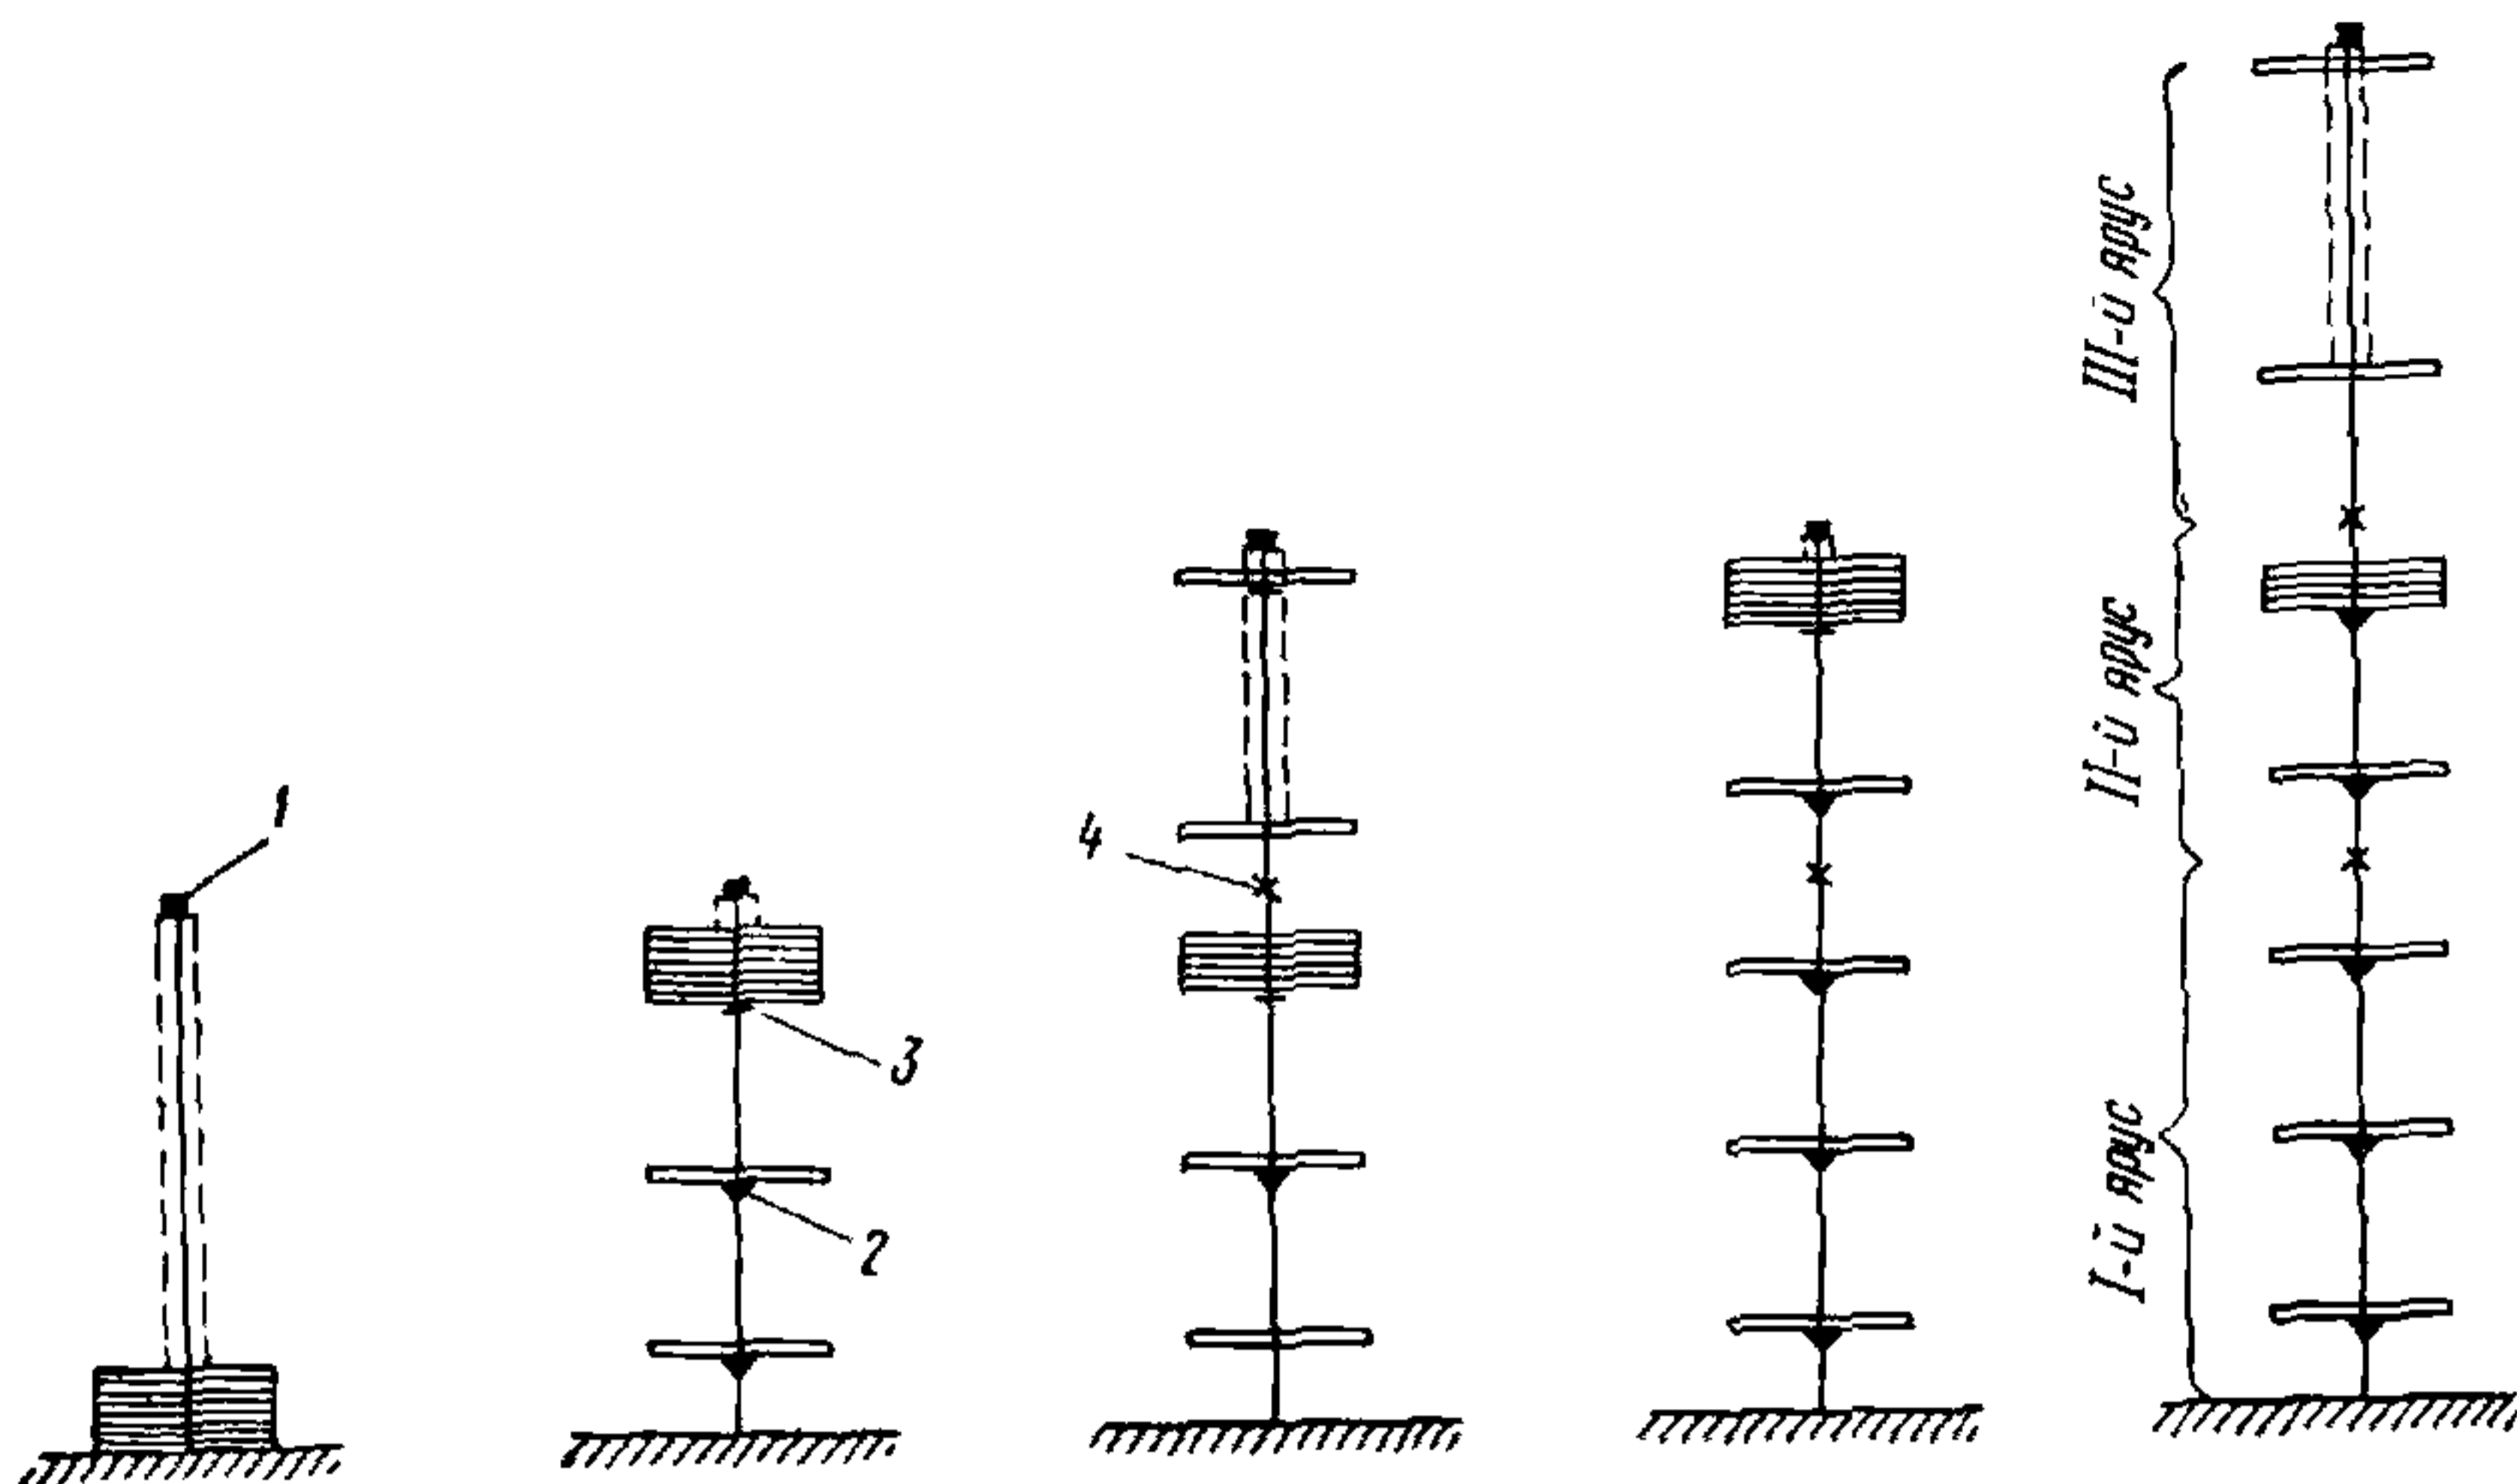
Этапы подъема, закрепления перекрытий и наращивания ярусов колонн
